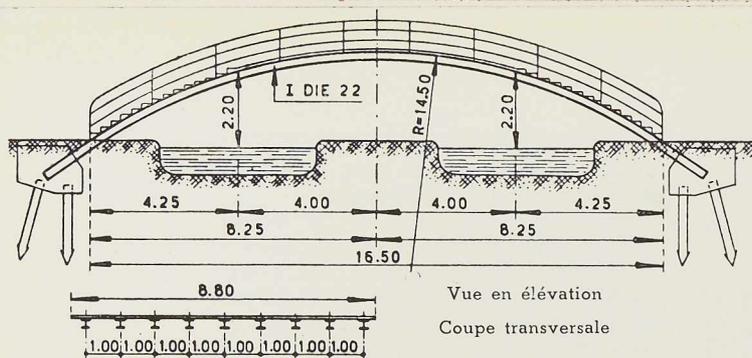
Pont enjambant les canaux des jardins, en face du pavillon de la Ville de Paris.
